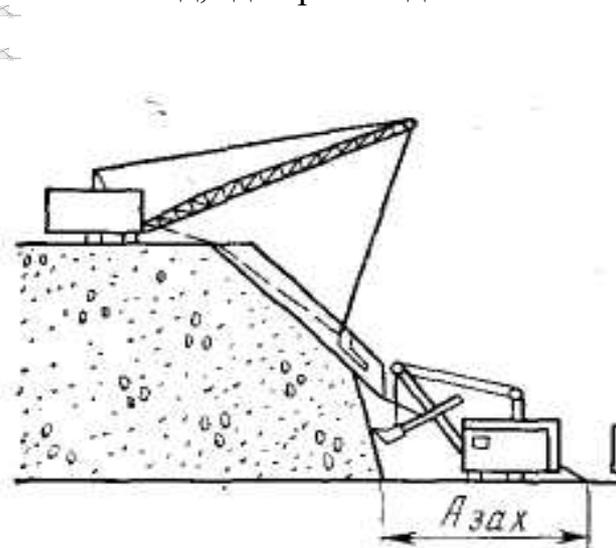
Схема разработки уступа с обрушением его верхней части
